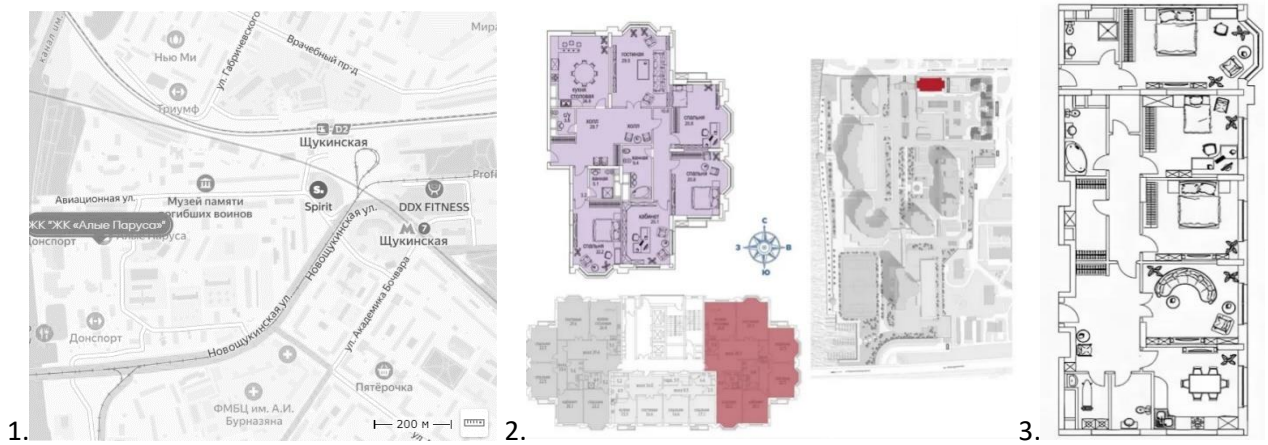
ЖК Алые паруса: 1. Размещение в структуре города. 2. Архитектурно-планировочное решение жилого комплекса с 5-комнатной квартирой на 29 этаже, 3. Трехкомнатная квартира на 25 этаже.
